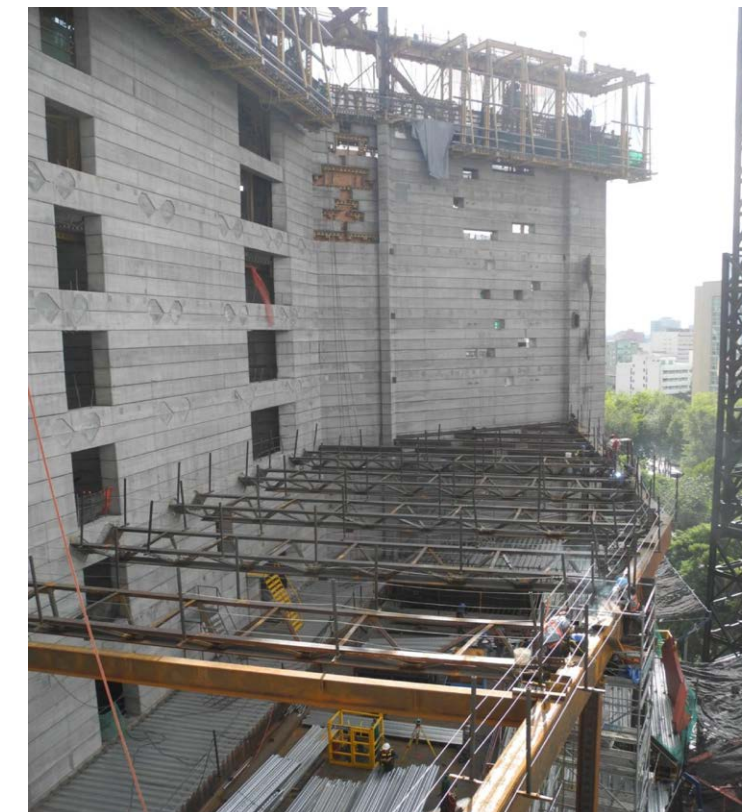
Muros de concreto en fachadas laterales, estructura metálica en la fachada principal y entre ambos elementos para dejar espacios utilizables sin columnas interiores.
